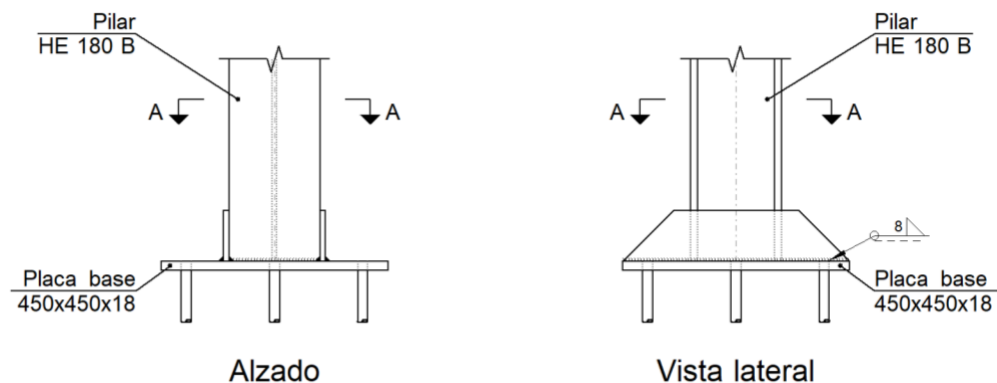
Alzado y vista lateral de la unión placa base-pilar. Fuente: CYPE 3D.
